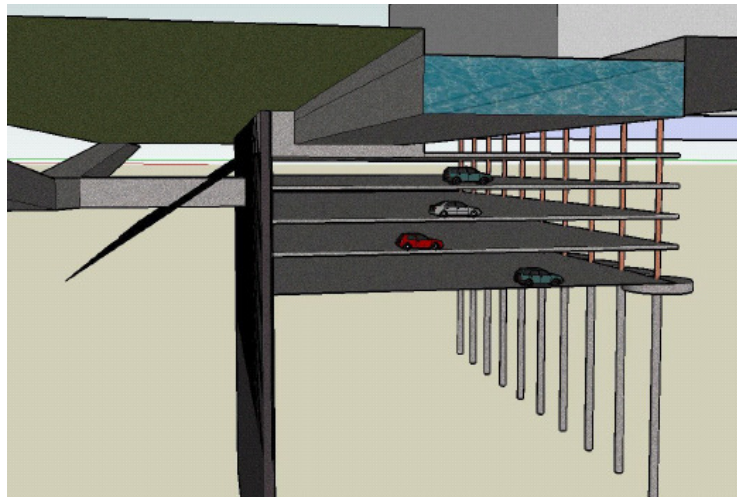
Le parking, avec les parois moulées et le canal (Van der Stoel et al. 2009b)
